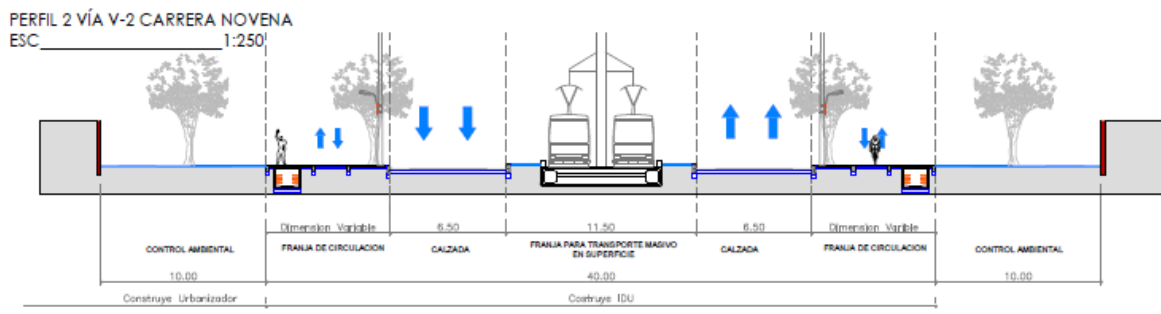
Perfiles malla vial arterial, avenida Laureano Gómez (avenida carrera 9ª).
